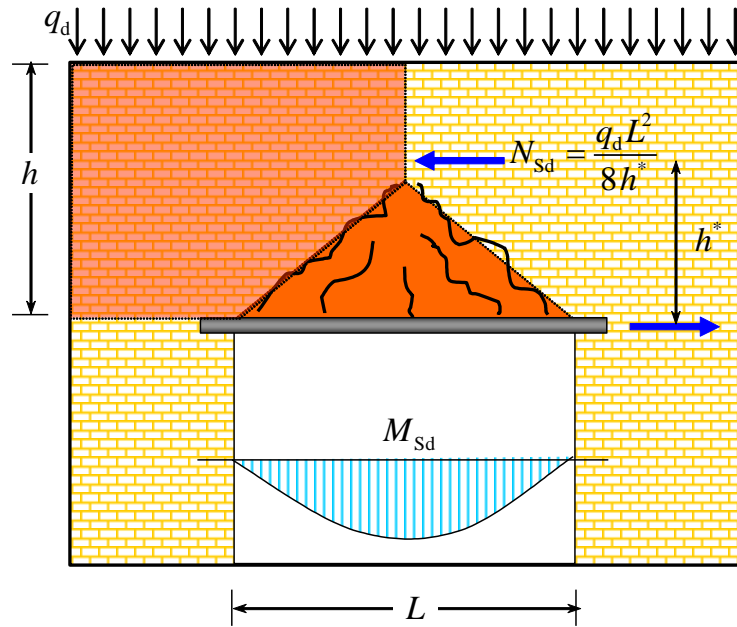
Schema di calcolo degli architravi a tensoflessione.
